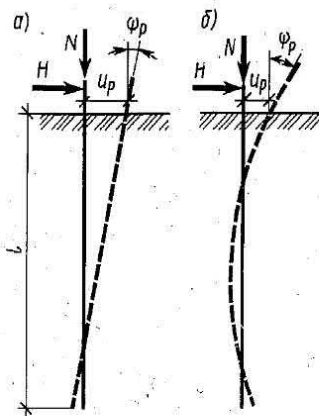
Схемы работы горизонтально нагруженных свай
